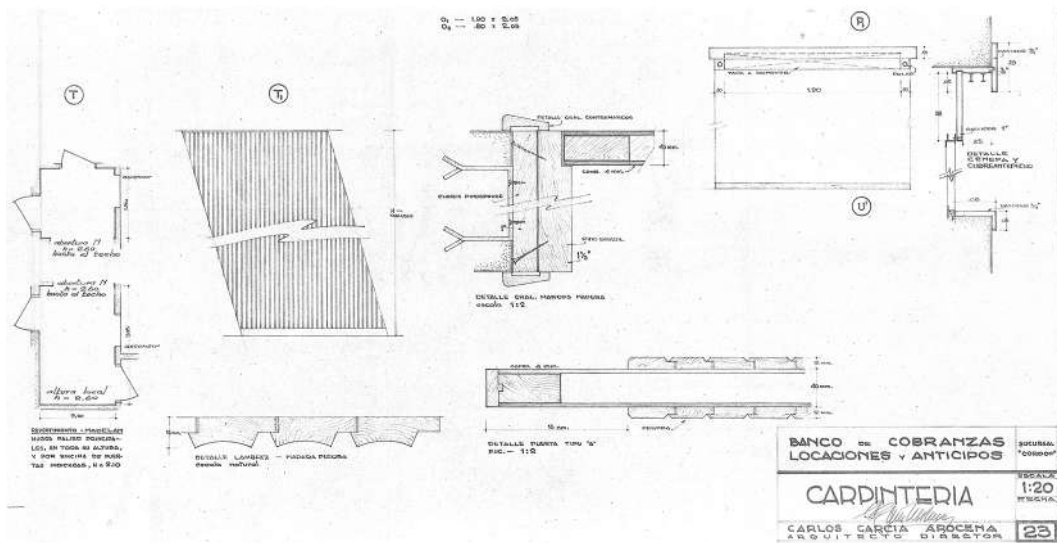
Detalle de la planilla general de carpintería de los recaudos ejecutivos del BCLA, donde se aprecia el diseño de las pieles interiores de madera.
